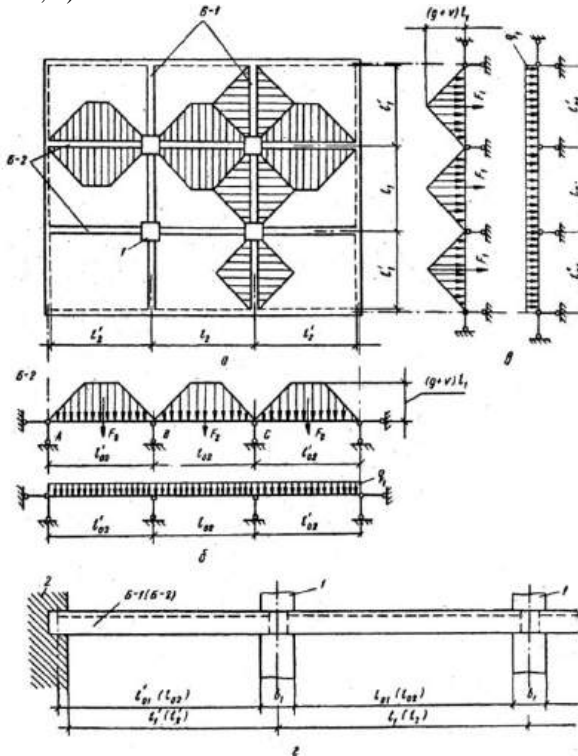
До розрахунку контурних балок: а – схема розподілу навантаження; б та в – розрахункові схеми; г – розрахункові прольоти; 1 – колони; 2 – стіна
